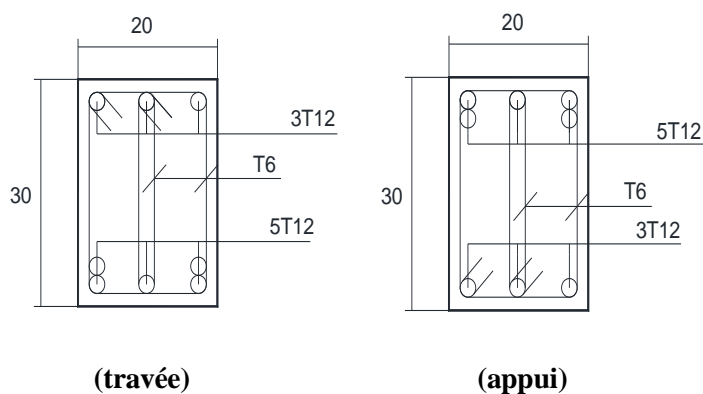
Ferrailage d'une poutre secondaire 20x30cm (plan régulier)
